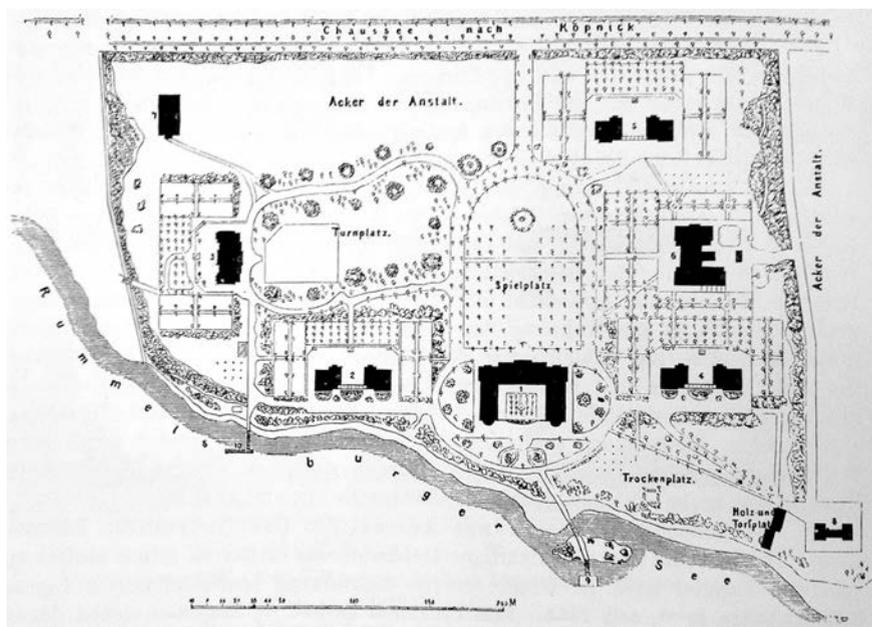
Städtisches-Waisenhaus Rummelsburg, Lageplan, erbaut, 1854-1859, Architekt: Gustav Holzmann, Druck 1896
